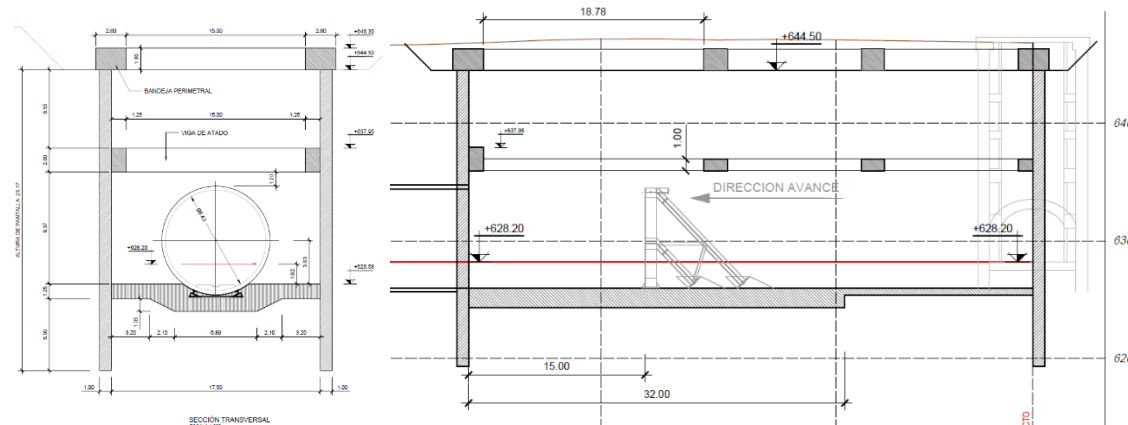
Sección transversal y longitudinal PAT-2 (Alt. 1-3)
